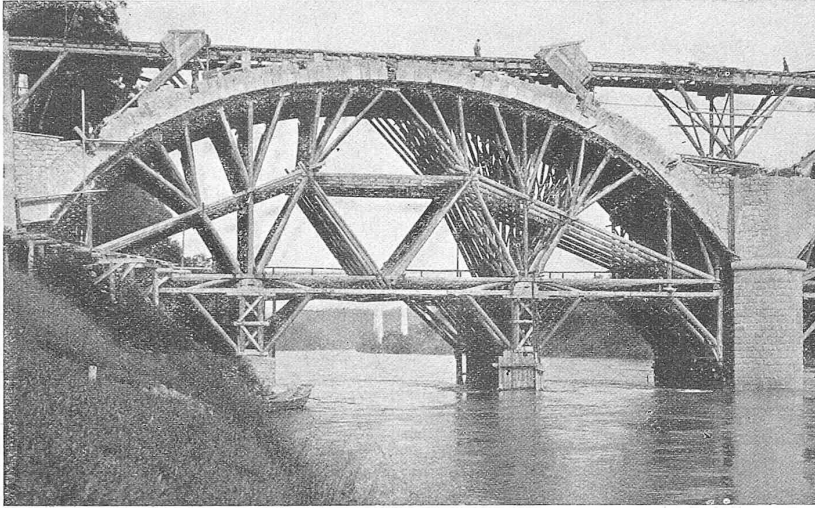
Lehrgerüst und Gewölbe der linksufrigen Oeffnung (26. VI. 1918).
